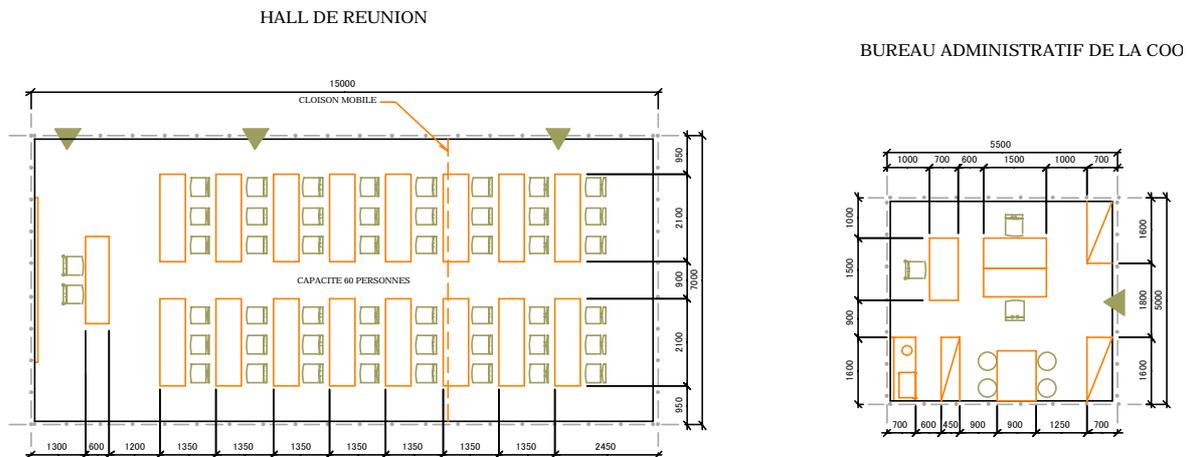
Plans horizontaux de la salle de réunion et du bureau administratif du groupement
